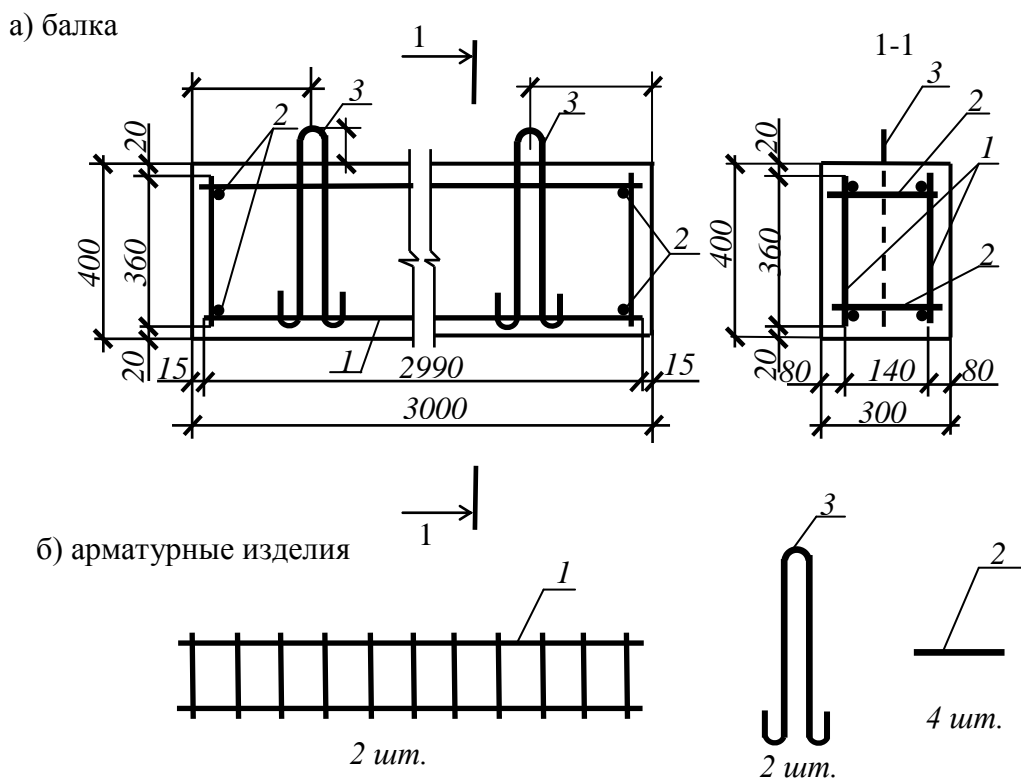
Чертеж схемы армирования балки и ее арматурные изделия
